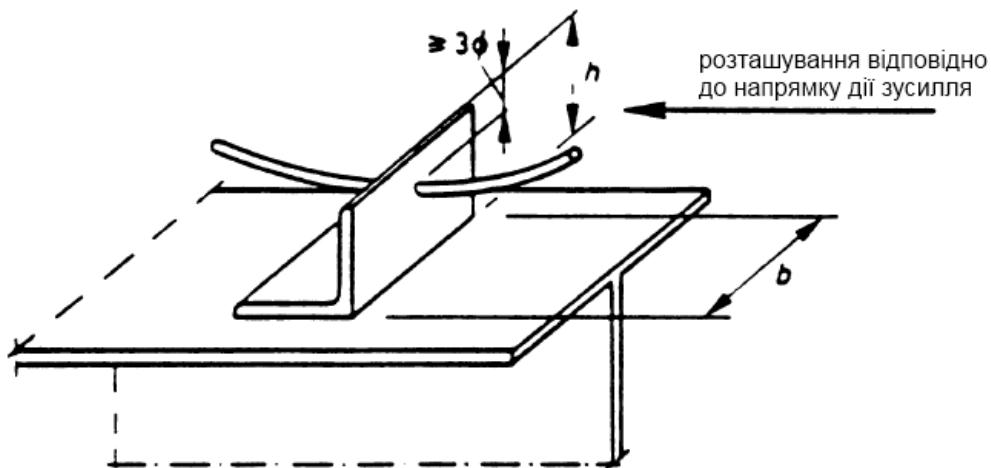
З'єднувальний елемент із кутика та арматурних петлів
